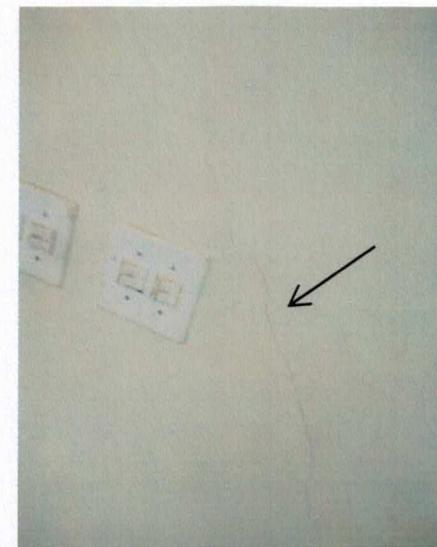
Foto da Parede: Fissura inclinada na parede - REFEITÓRIO
